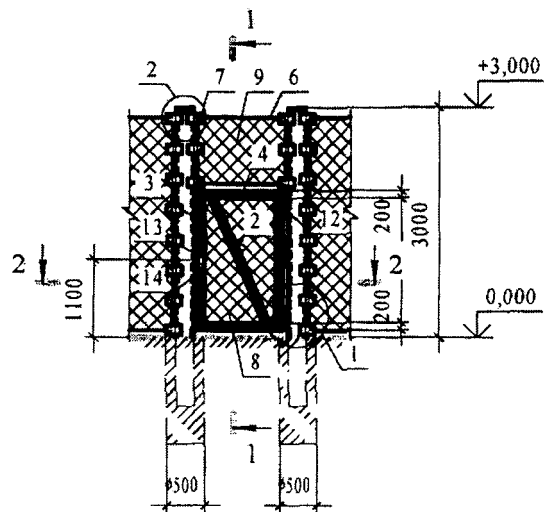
Калитка в ограждении из металлической сетки высотой 3,0 м на железобетонных стойках
